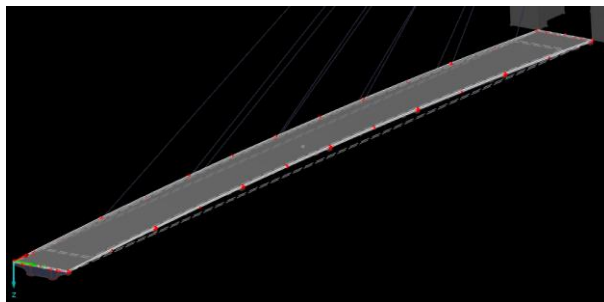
TABLERO DE HORMIGÓN HA-30
